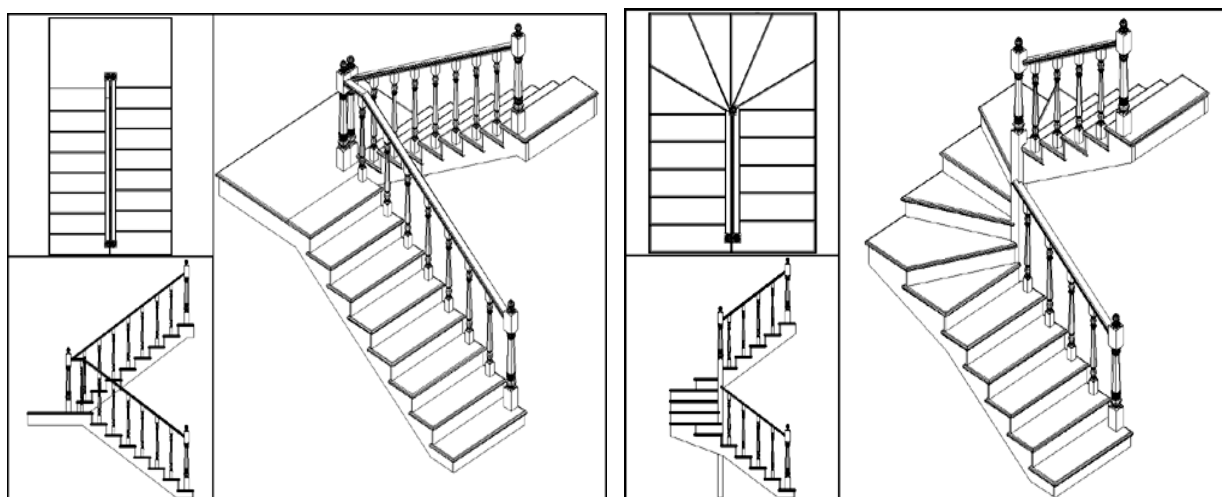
Чертеж двухмаршевой лестницы (с промежуточной площадкой и с забежными ступеньками).
